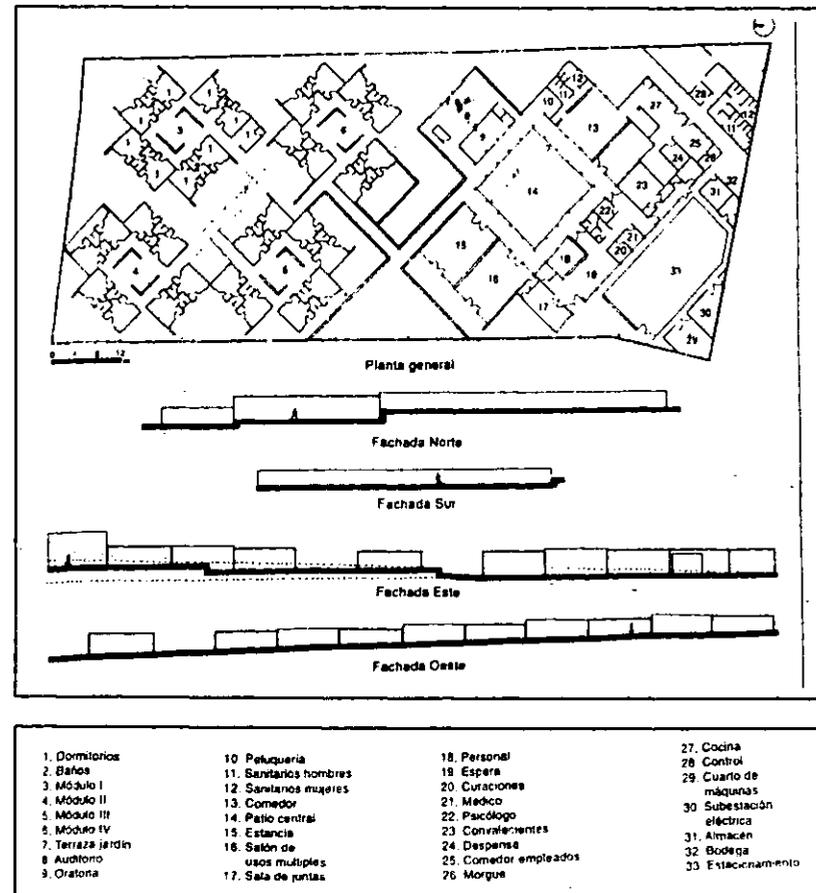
Planta arquitectónica de la Casa Hogar Olga Tamayo.
